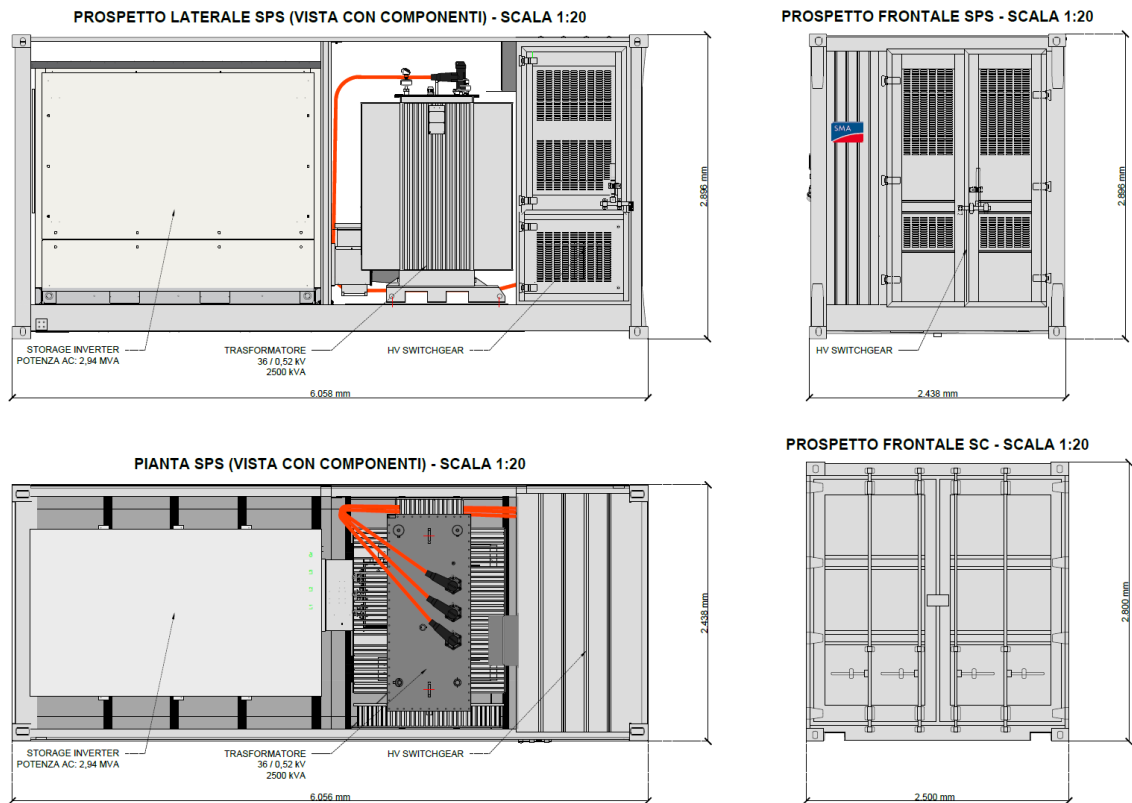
Pianta e Prospetto dello Storage Power Station con Storage Inverter
